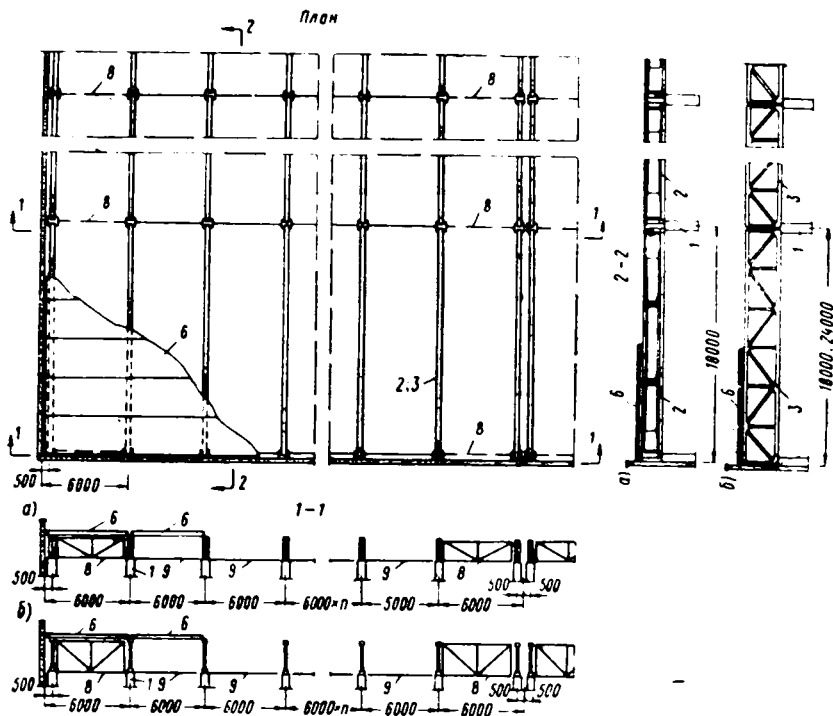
Конструктивная схема I покрытия зданий с плоской кровлей
